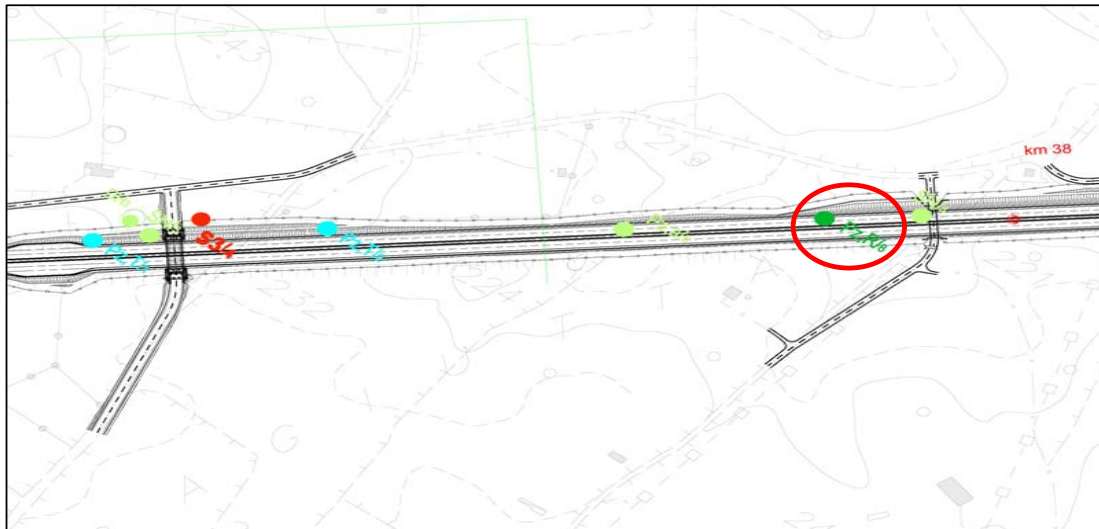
FOTO SATELLITARE CON PROIEZIONE DEL POZZETTO PZR8
